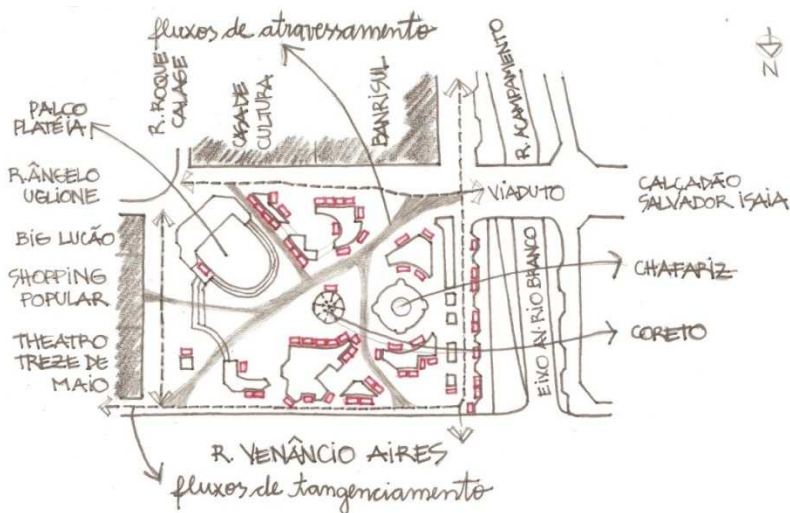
Ilustração esquemática da planta baixa e dos principais fluxos da Praça Saldanha Marinho. FONTE: a autora.
